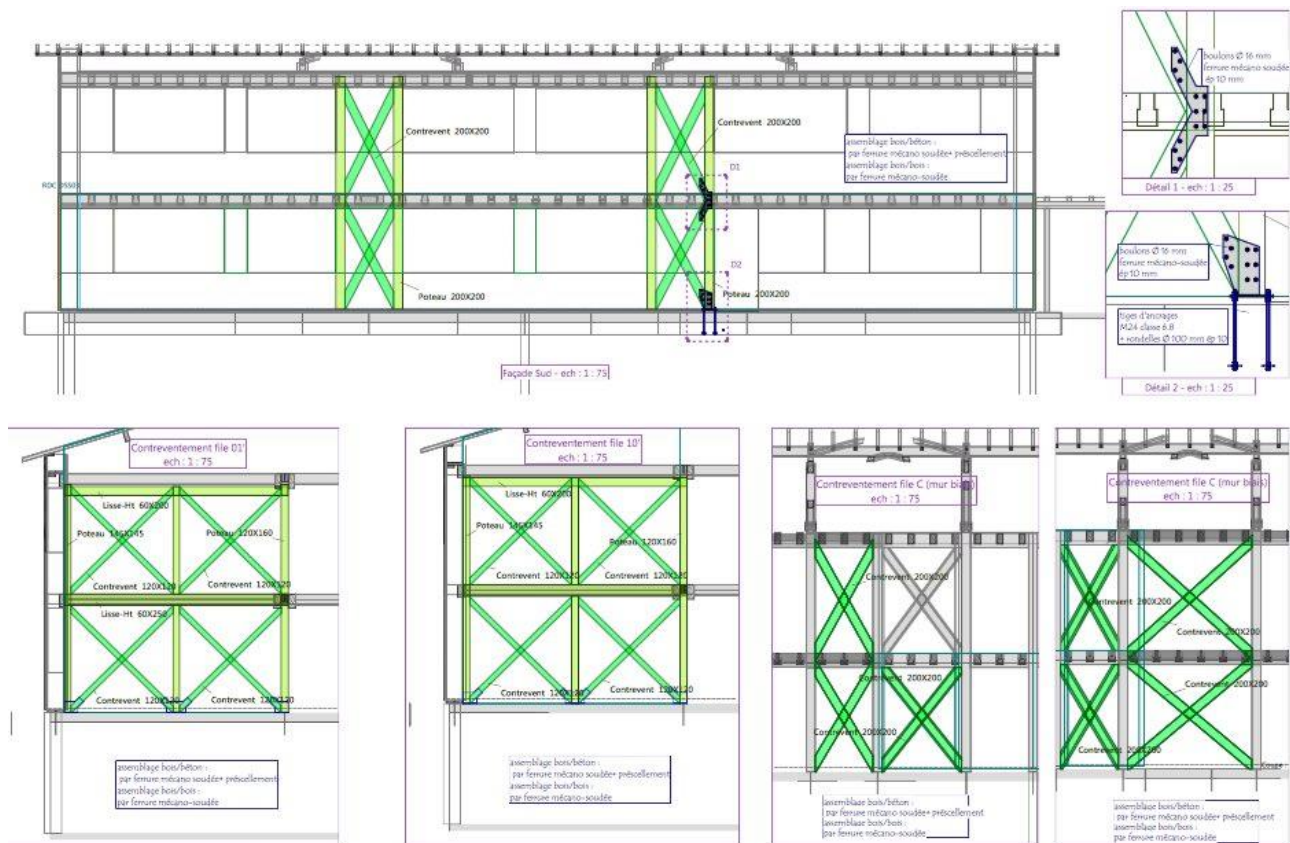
Plans de coupe mettant en évidence les croix de saint André
